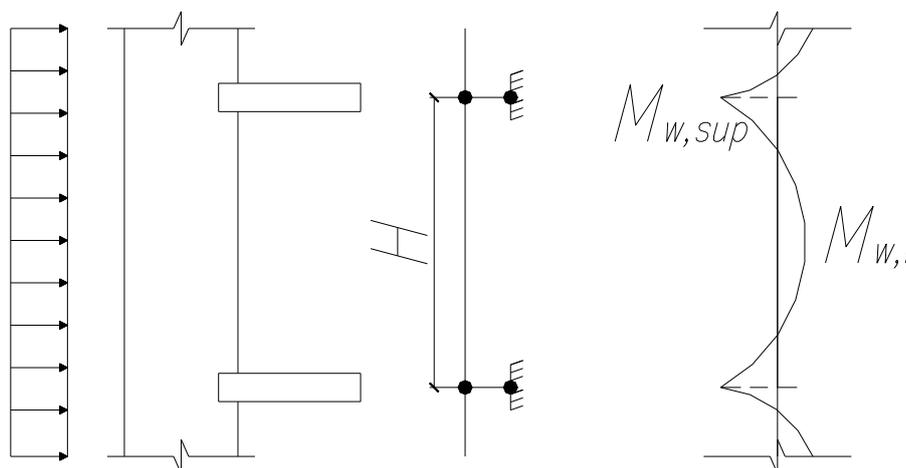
Расчетная схема стены при действии ветровой нагрузки
